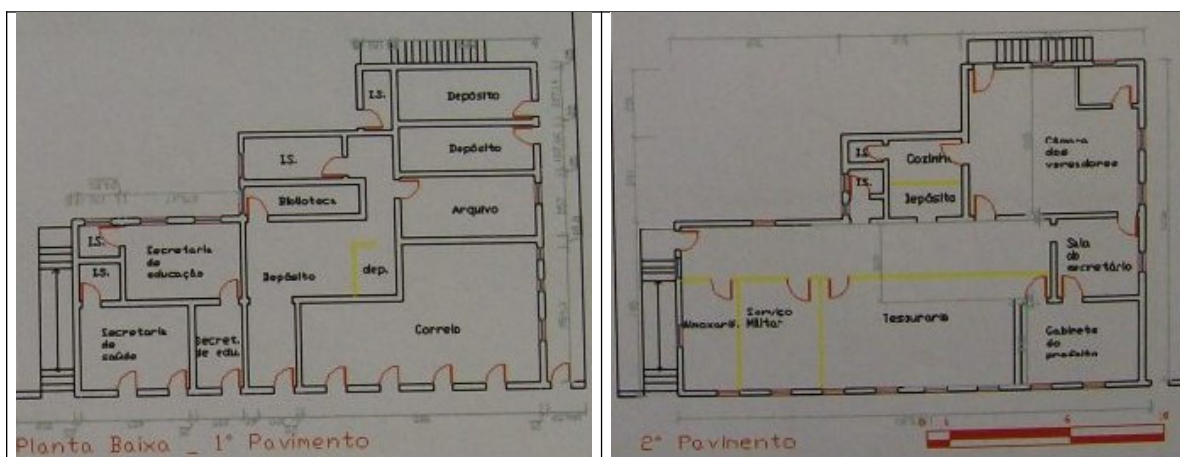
e 7- Planta baixa do 1º e do 2º pavimento do prédio da Antiga Prefeitura de Presidente Bernardes. Fonte: Dossiê de Tombamento do imóvel, consultado junto ao IEPHA em 03/07/2012.
